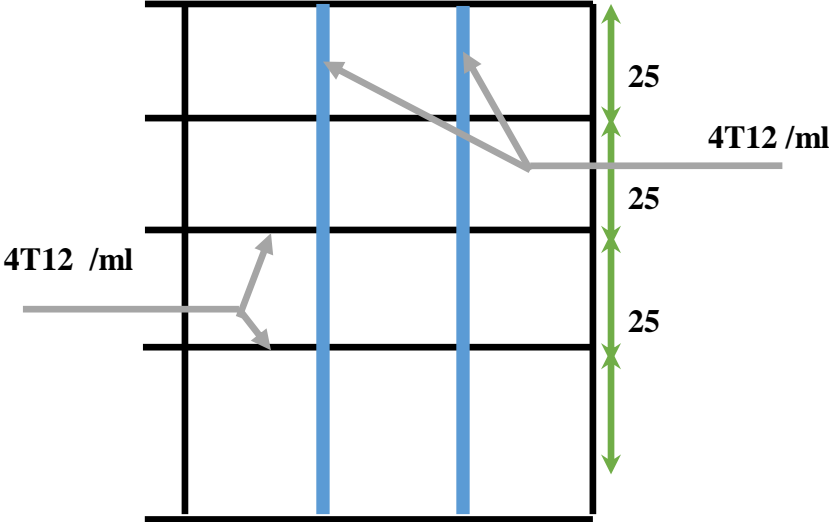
Ferrailage en travée de la dalle machine(e=25cm)
